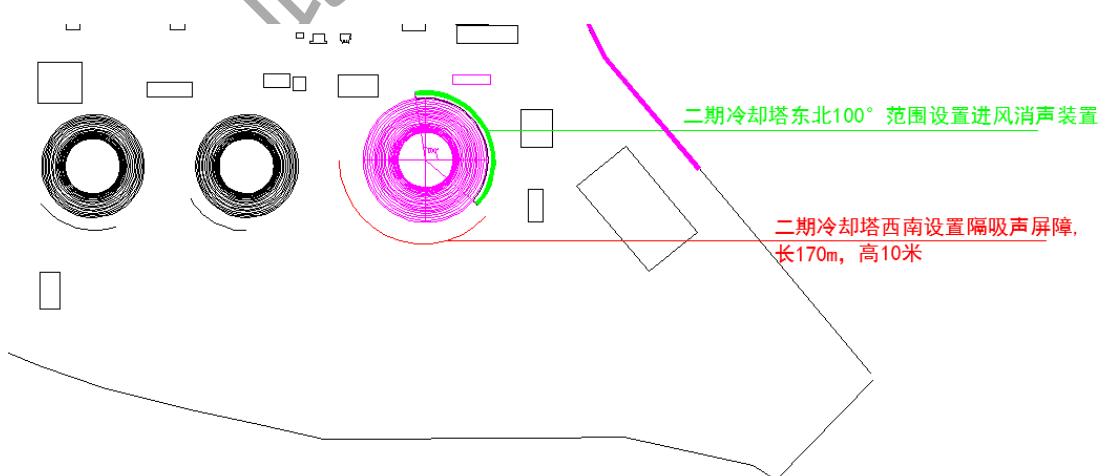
冷却塔区域噪声控制平面布置示意图
